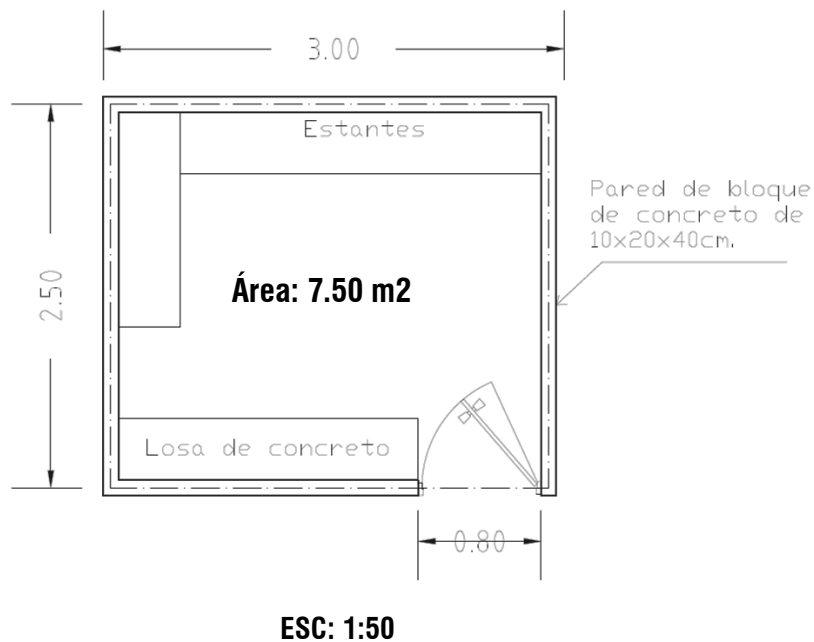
Planta Arquitectónica de puesto tipo para productos secos
